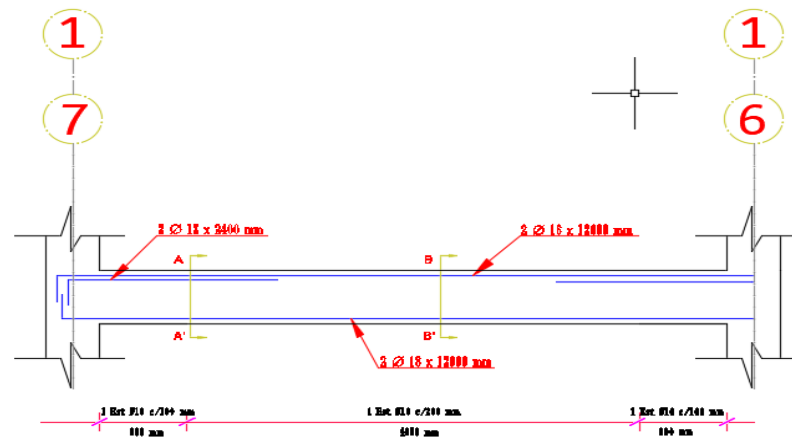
Detalle de viga principal eje "Y" piso 5.
